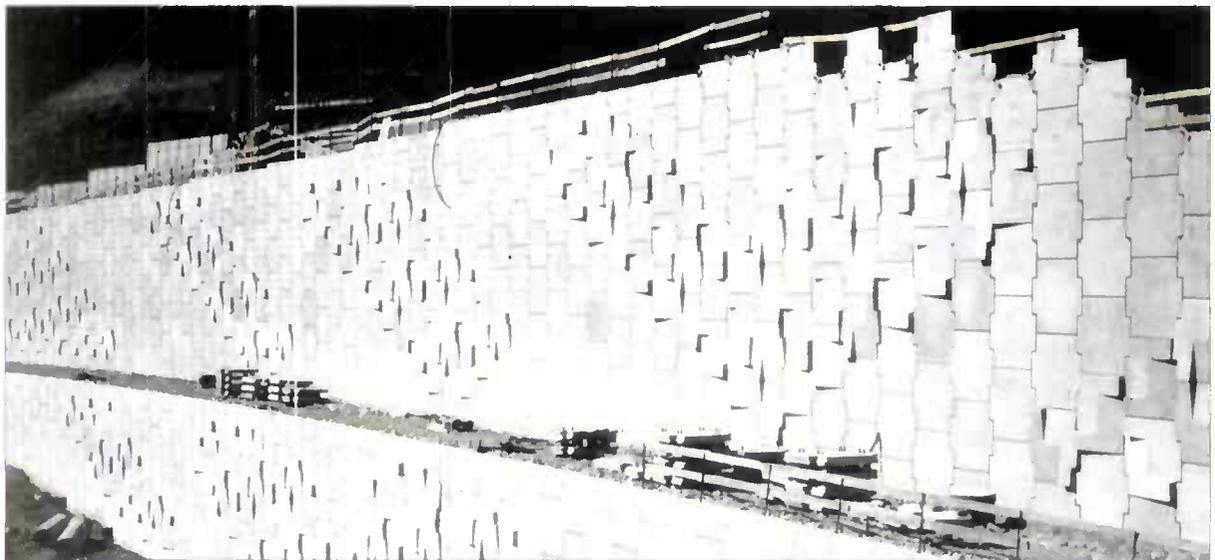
Réalisation d'ouvrages en gradins en site montagneux
